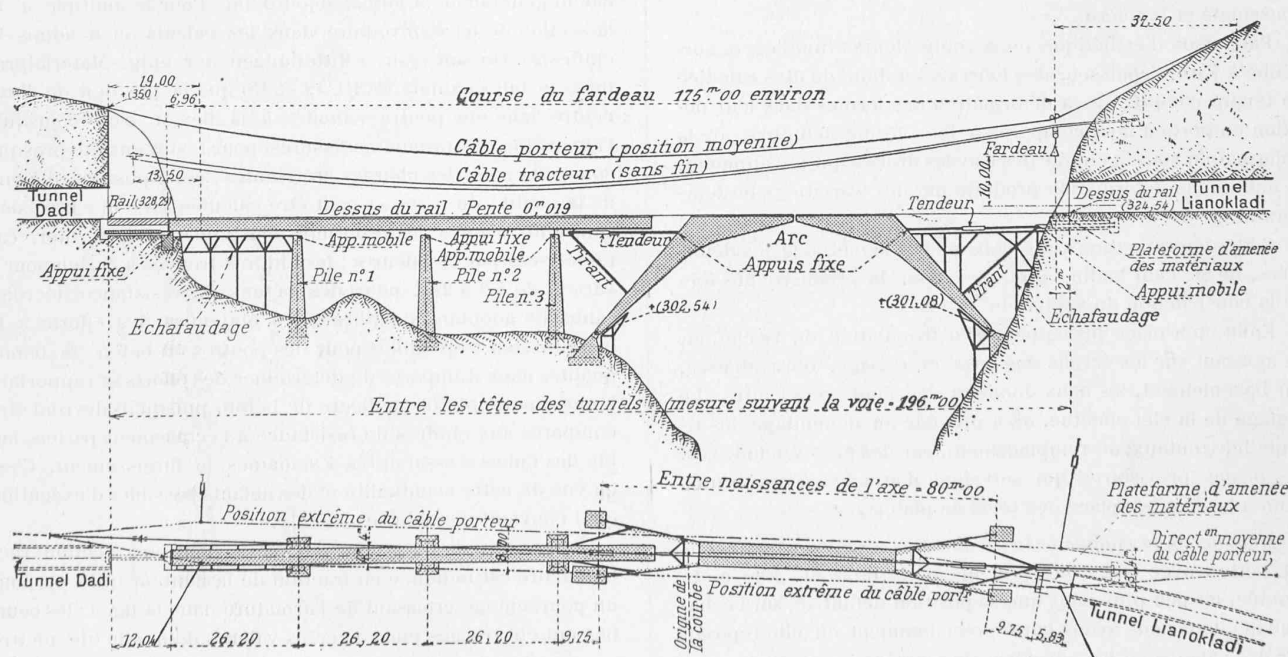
et 5. — Elevation et plan du viaduc pendant les travaux de montage.
